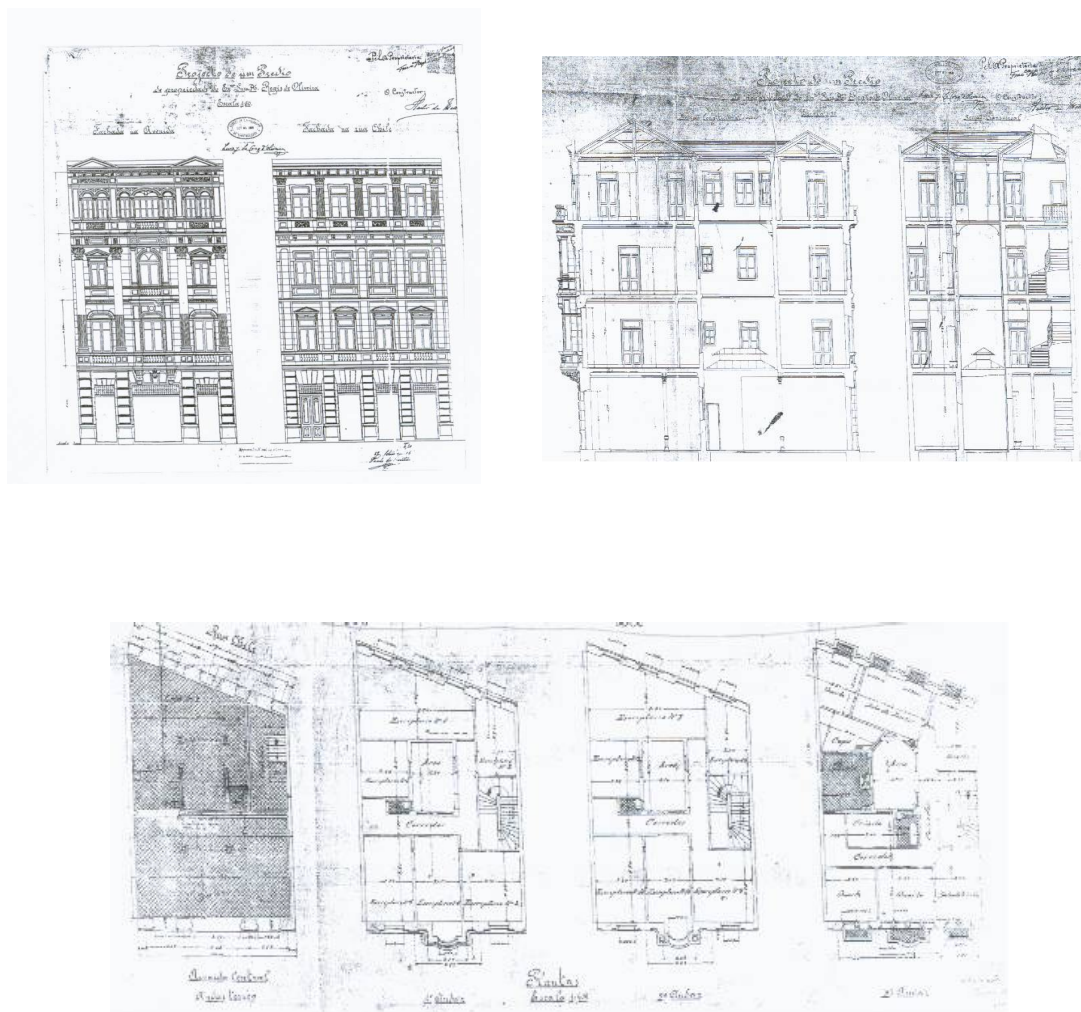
Reprodução parcial da planta original - plantas 1º, 2º, 3º pavimentos Edifício do Sr. Francisco Regis de Medeiros. Fonte: Arquivo Nacional
